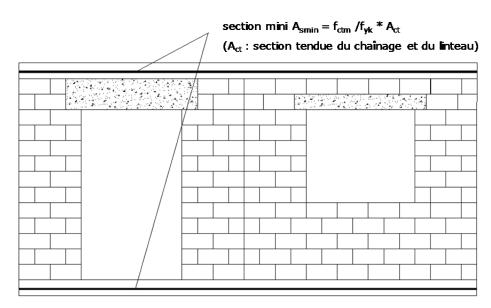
Dispositions de ferraillage de renfort des façades en maçonneries
